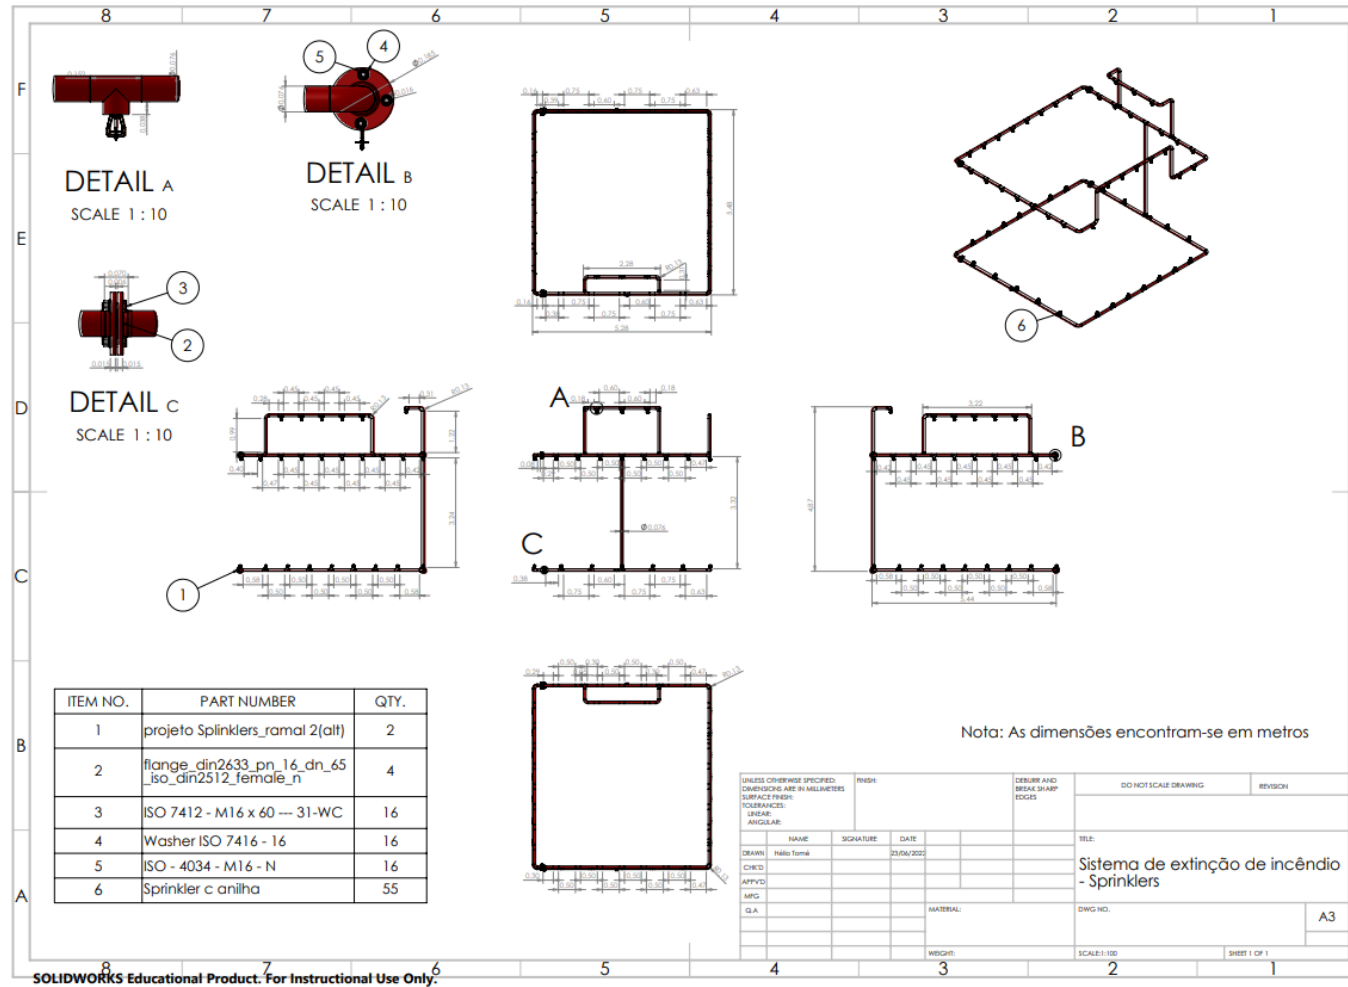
Anexo IV - Desenho técnico cotas do SAEI(Sprinklers)
